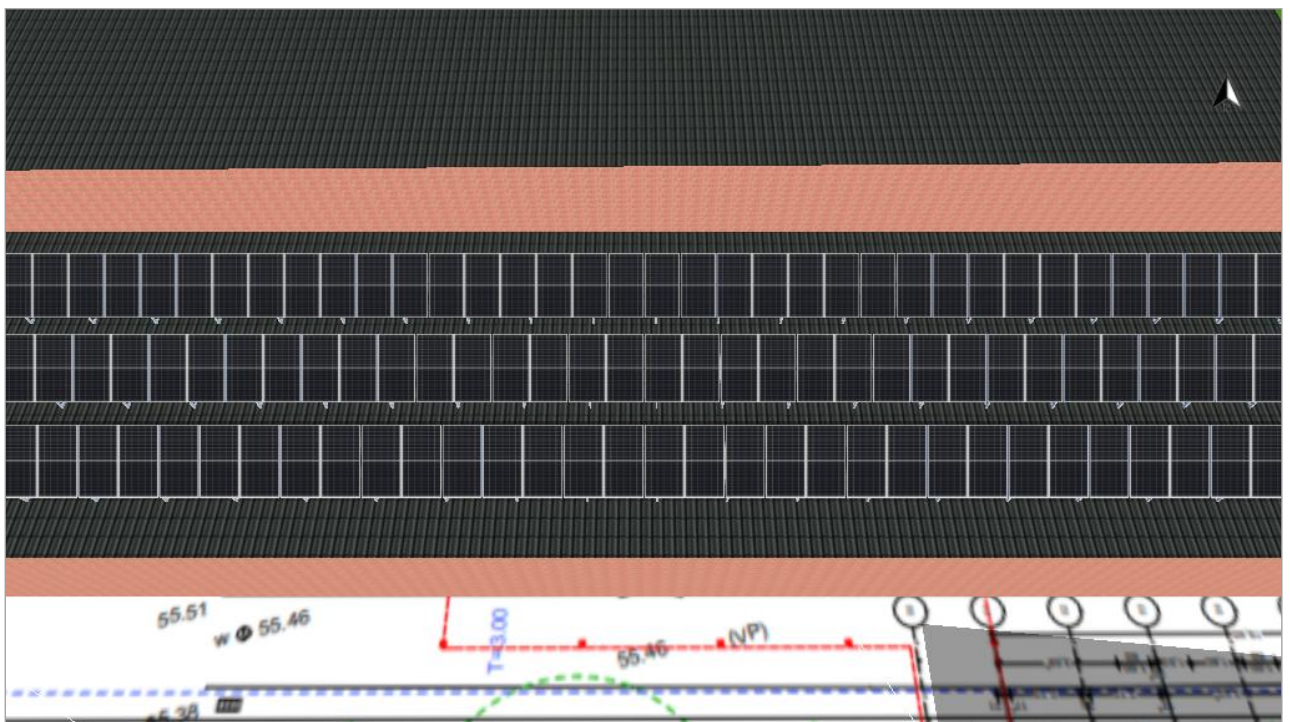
Modulfläche - Sporthalle -Belegungsfläche Nord
